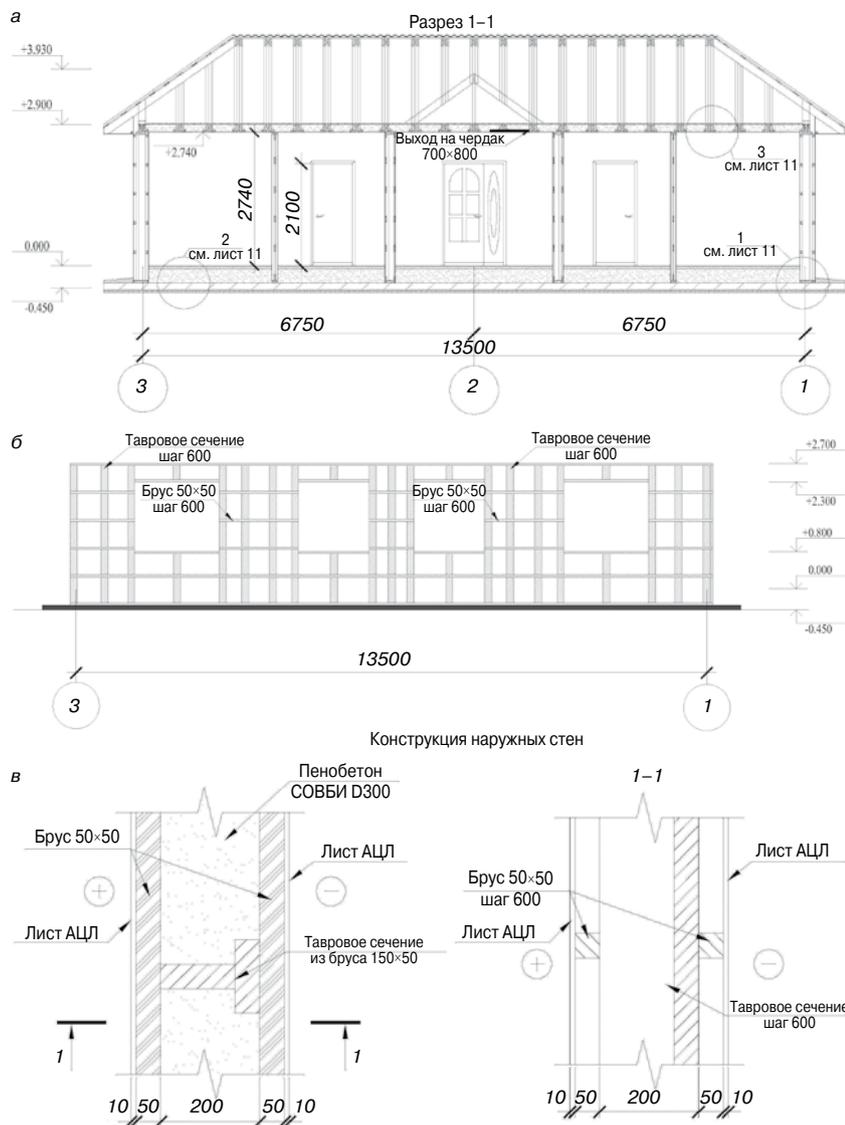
Примеры и узлы каркаса типового проекта: а – типовая раскладка каркаса; б – типовая конструкция наружных стен; в – разрез здания с деревянным каркасом и утеплением пенобетоном
